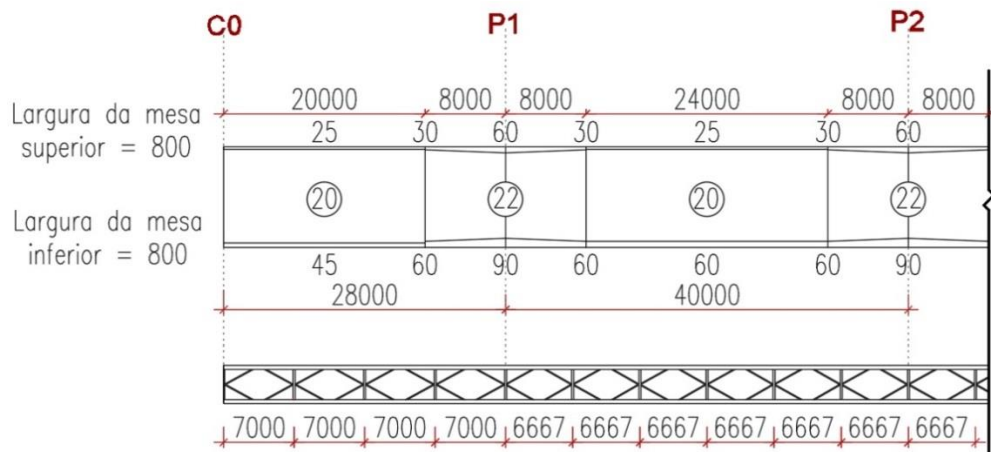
Corte longitudinal da estrutura metálica principal e vista inferior (dimensões em mm)
